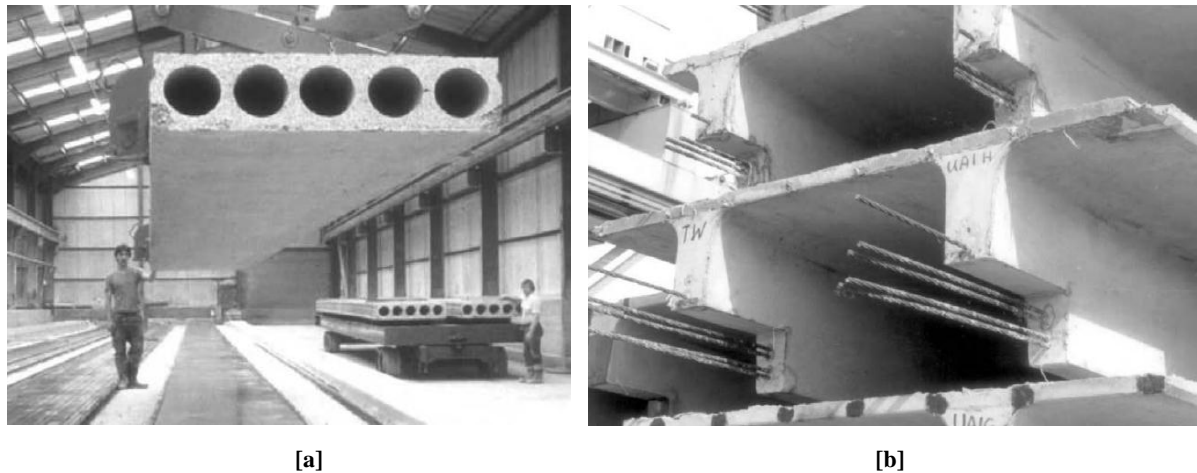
3 – Tipologias mais comuns de lajes pré-fabricadas: [a] Laje alveolar; [b] Laje PI ou duplo T (FONTE: Elliot, 2002).
